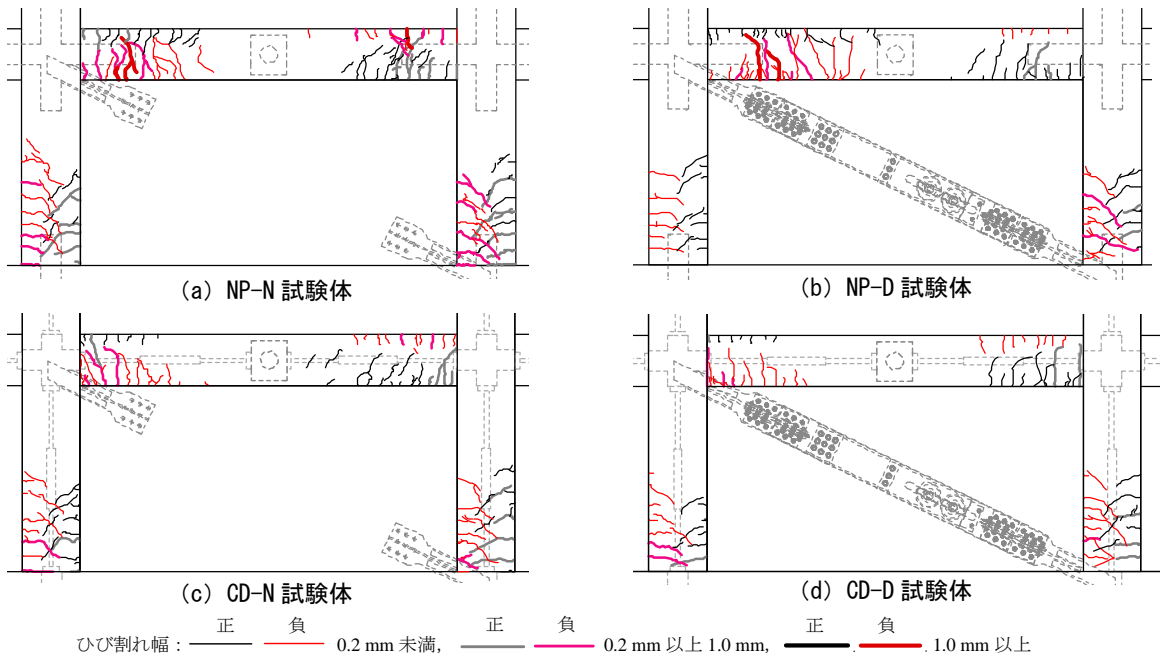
ひび割れ状況 ($R=\pm 1/100$ rad. 時)
